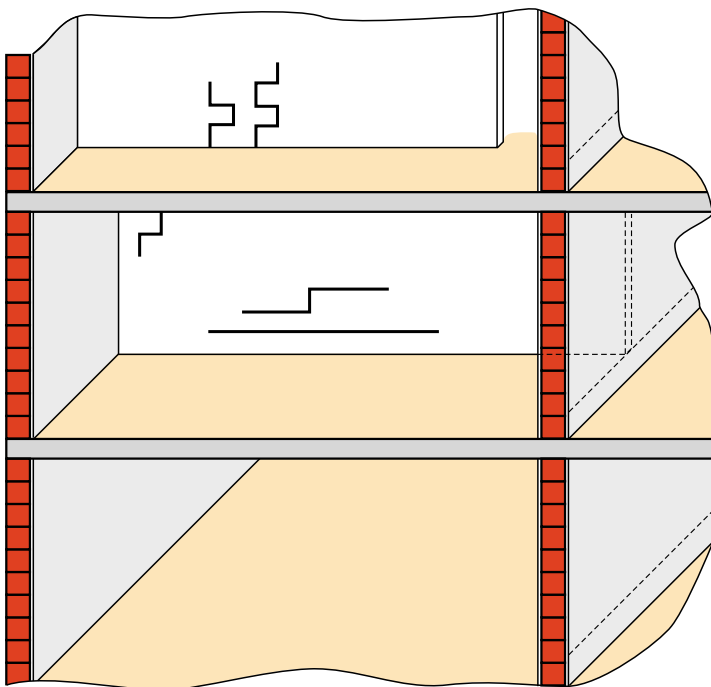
Typisches Rissbild in nichttragenden Trennwänden auf Deckenplatten mit erhöhter Deckendurchbiegung
